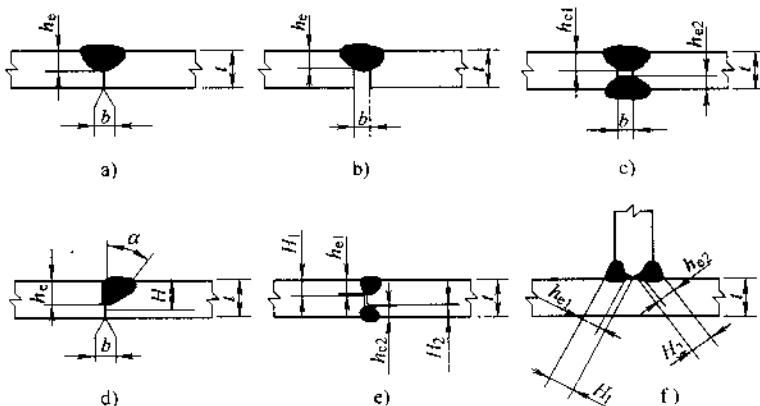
部分焊透的对接焊缝及对接与角接组合焊缝计算厚度示意
